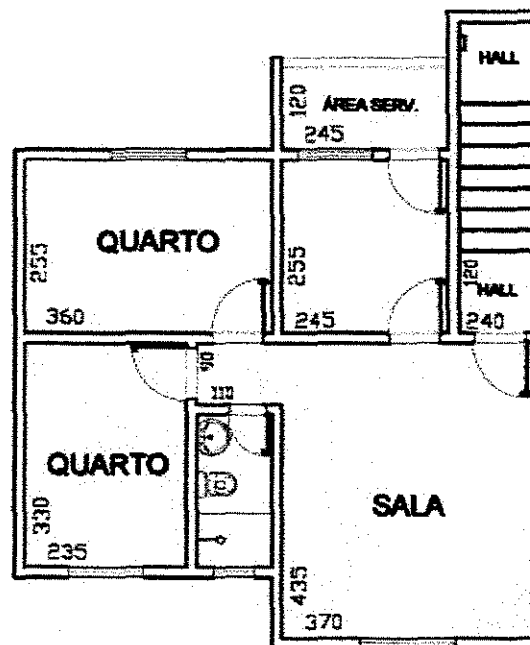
Planta baixa do apartamento do edifício 1.
